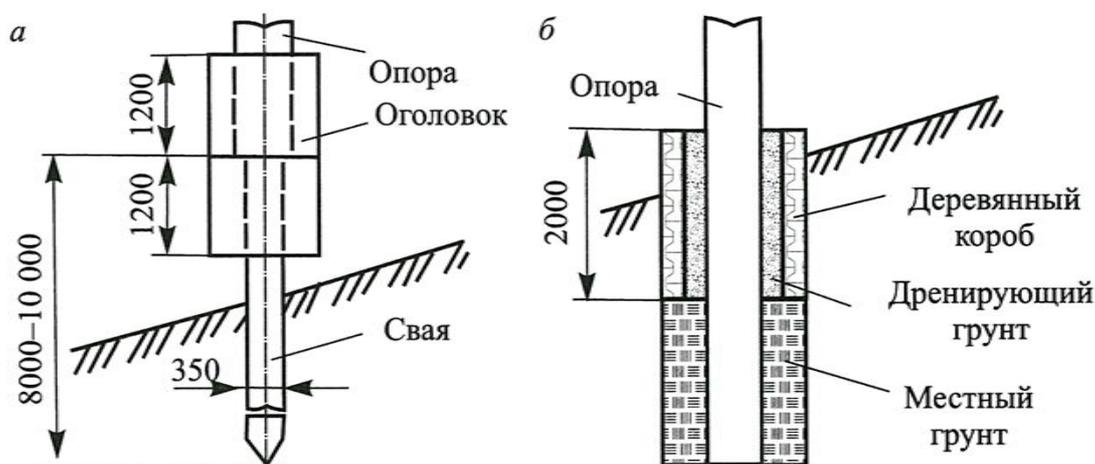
Установка опор на свае (а), в пучинистых грунтах (б)
